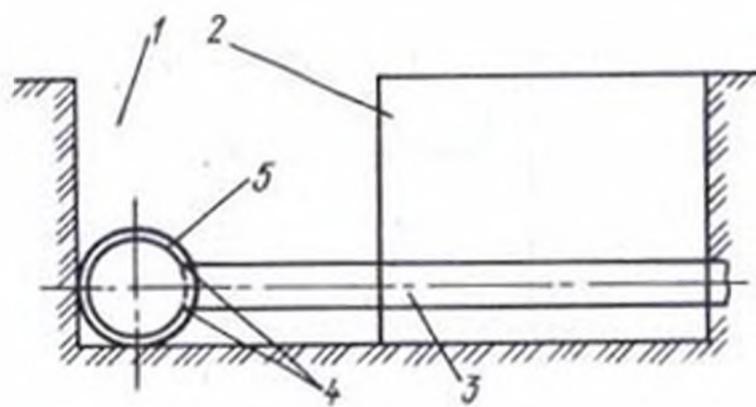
Схема соединения оросительного и увлажнительного трубопроводов:
